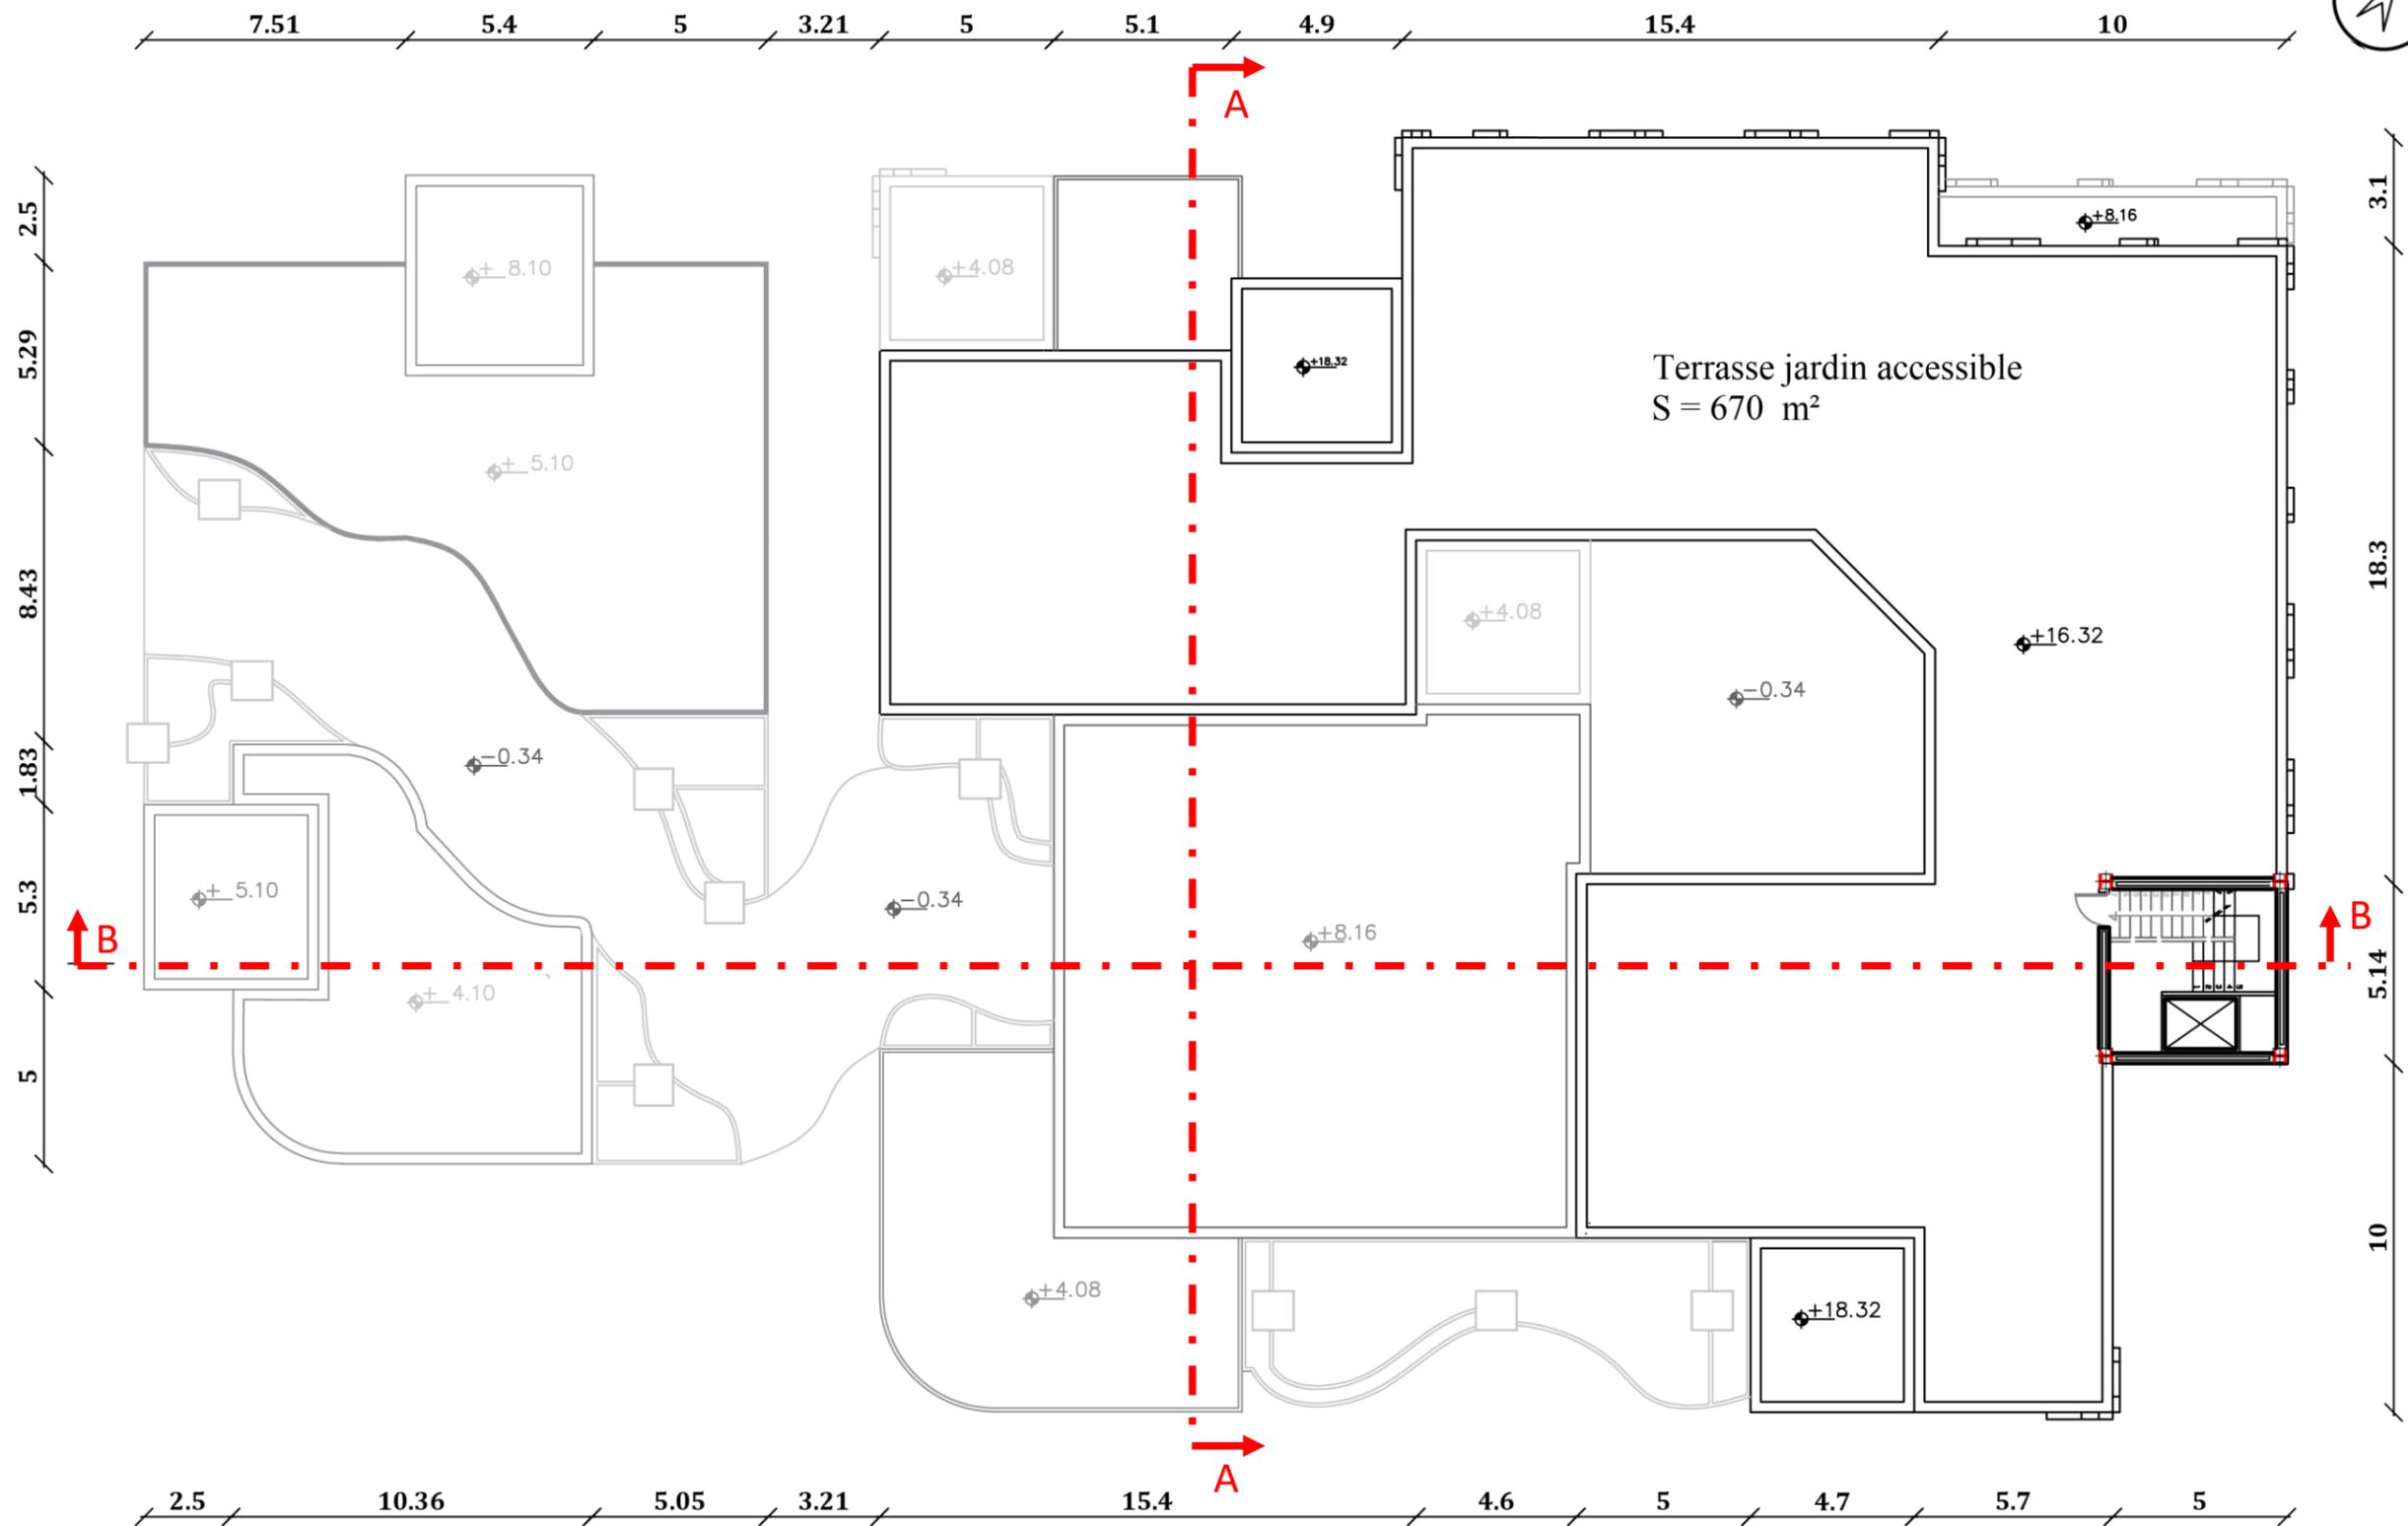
plan de la terrasse jardin. Échelle 1/200.
